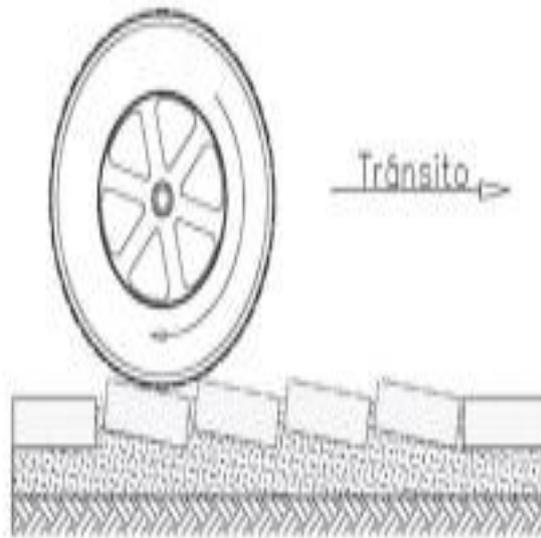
40 Escalonamiento Entre Adoquines [34].
